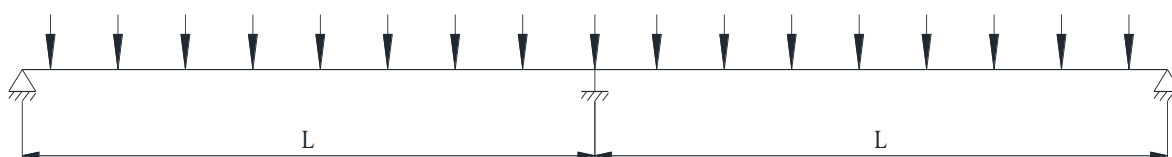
Расчетная схема нагружения двухпролетной панели
